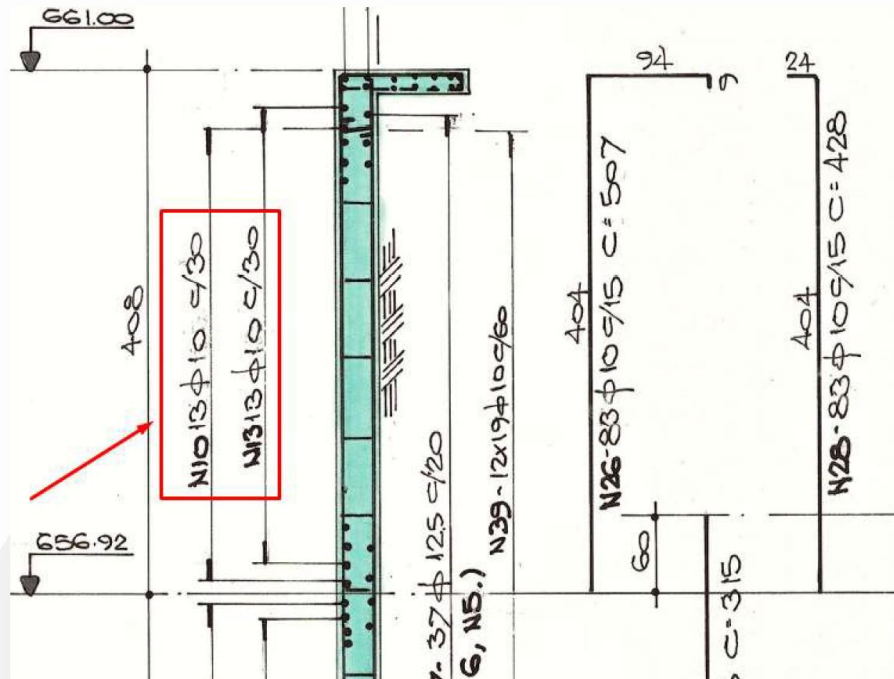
Detalhe em corte das armaduras das paredes 02 e 07
